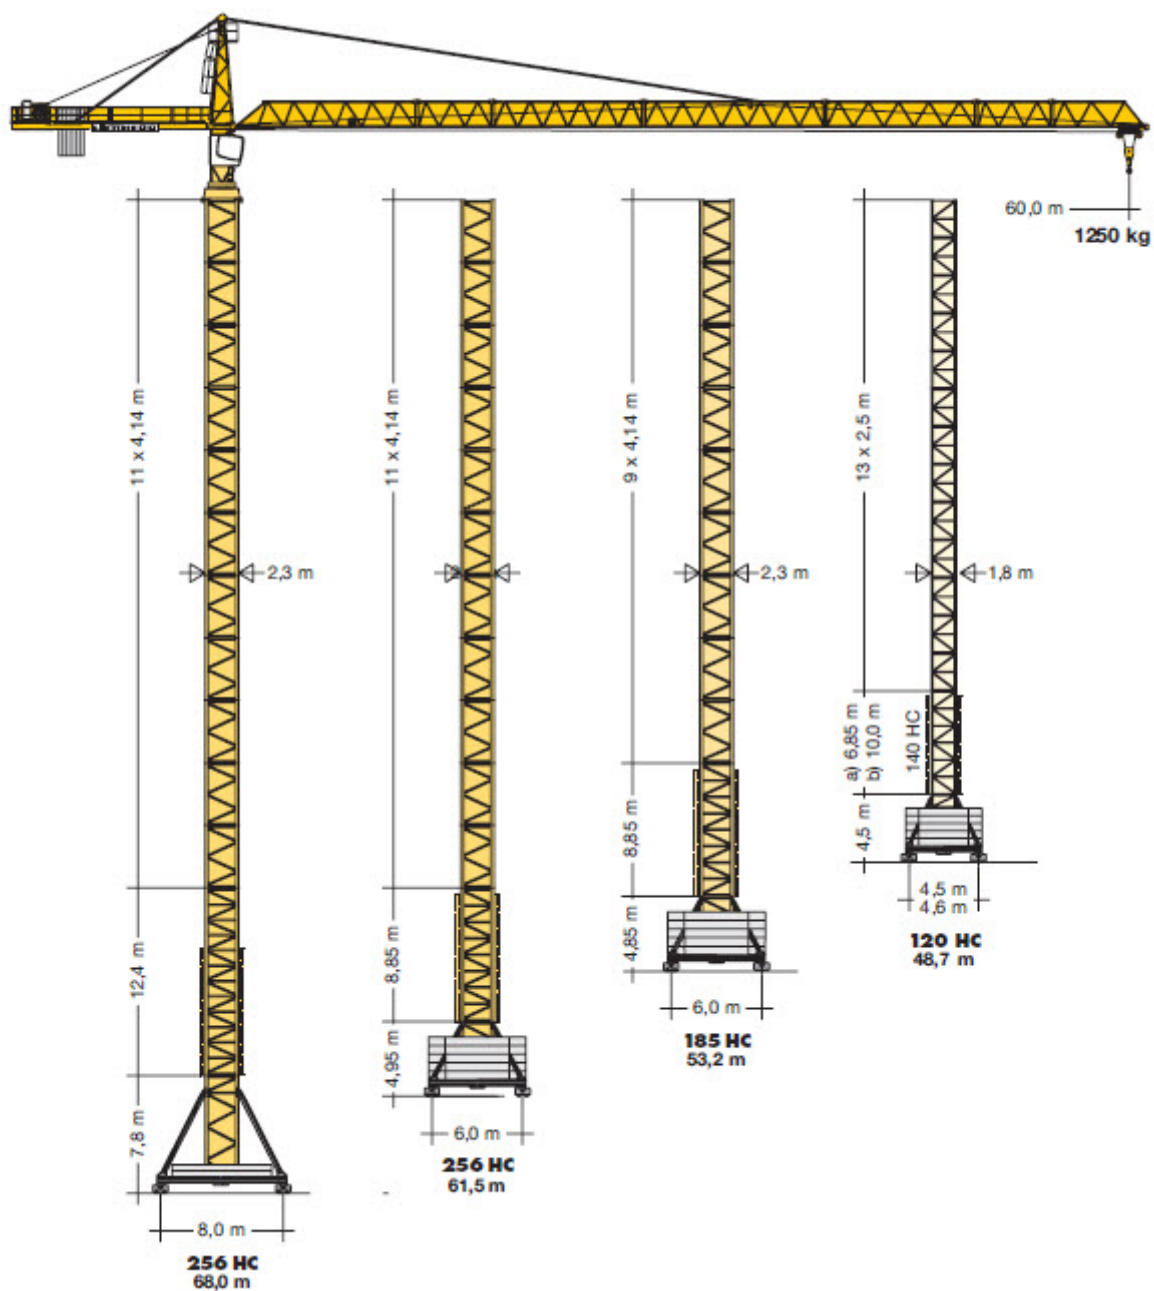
Баштовий кран Liebherr 140 EC-H10
